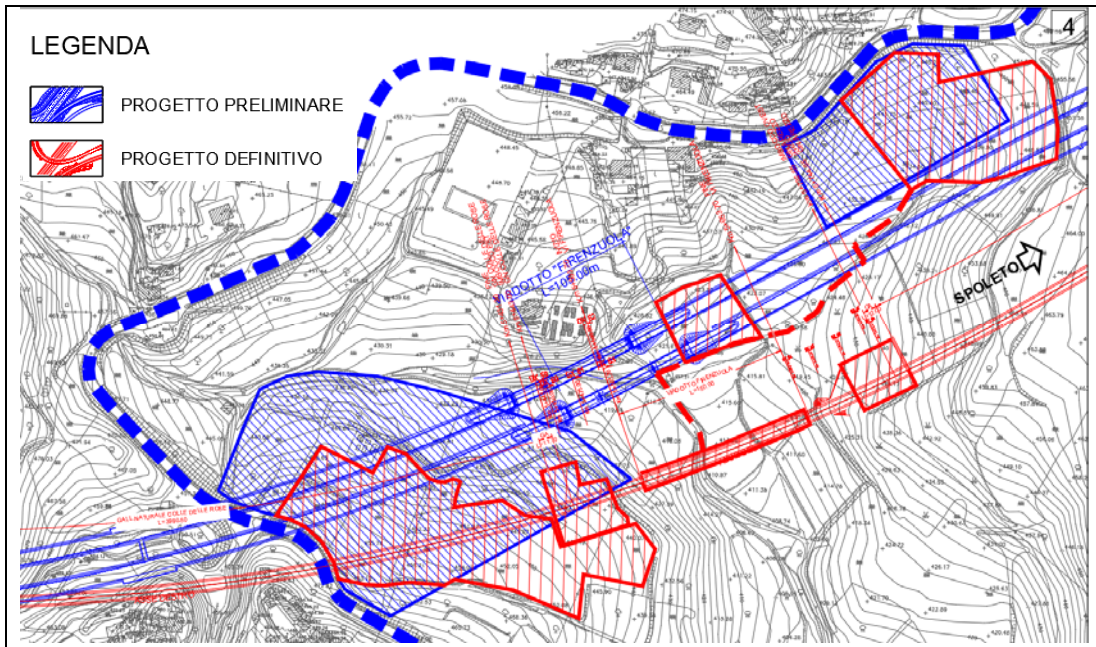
Planimetria di sovrapposizione del progetto definitivo al progetto preliminare Viadotto Firenzeuola
